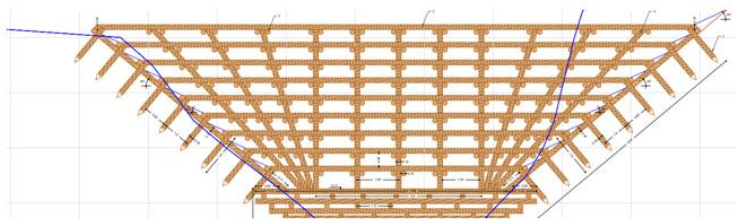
Dimensões e detalhes construtivos do muro de suporte vivo.
